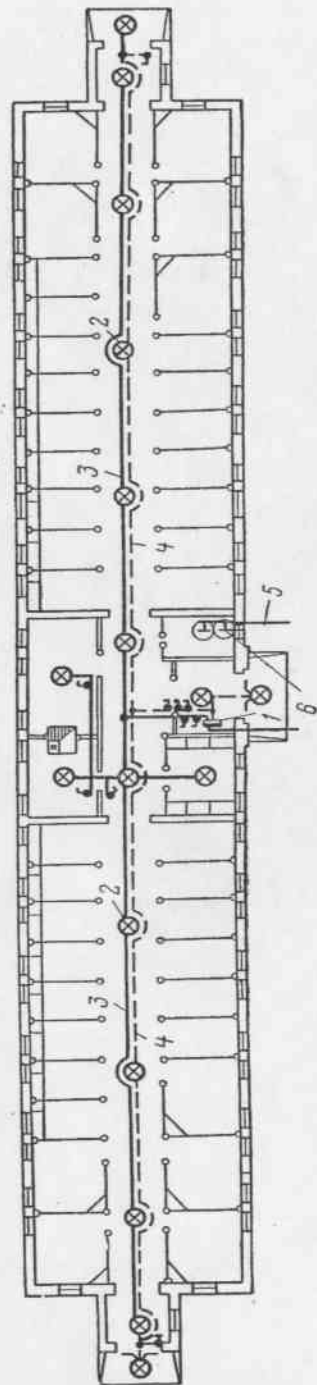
План конюшни на 40 рабочих лошадей со схемой сетей электроосвещения и водопровода: 1—групповой щиток; 2—арматура фарфоровая полугерметическая; 3—сеть рабочего освещения; 4—сеть дежурного освещения; 5—ввод от наружного водопровода; 6—бочки для воды.
